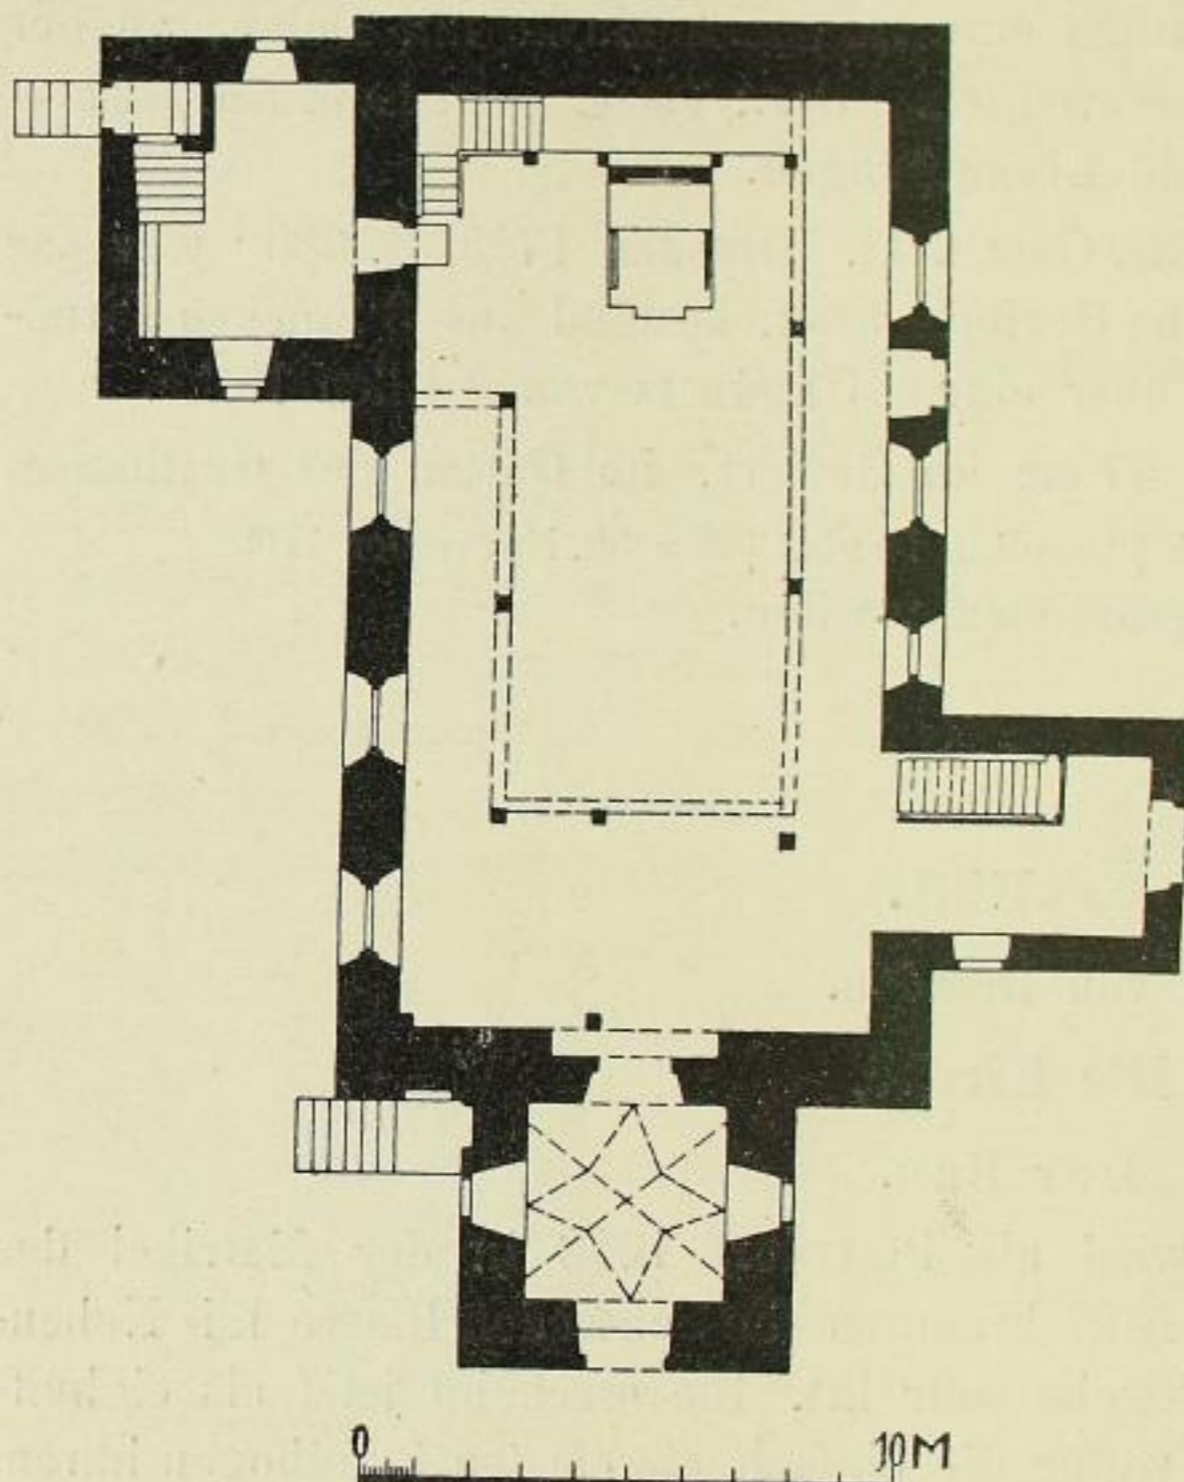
Lausa, Grundriss der Kirche.
